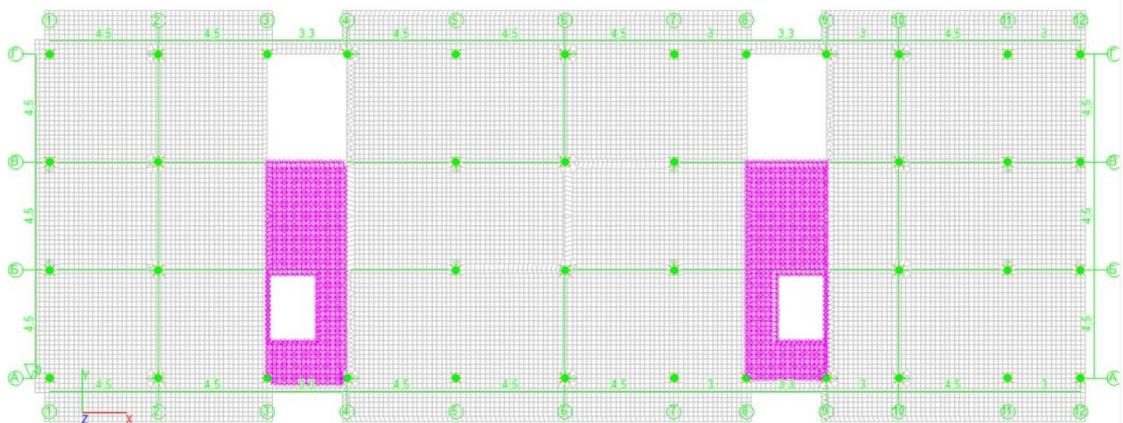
Общий вид временного загрузения перекрытия эксплуатационной нагрузкой в холле
